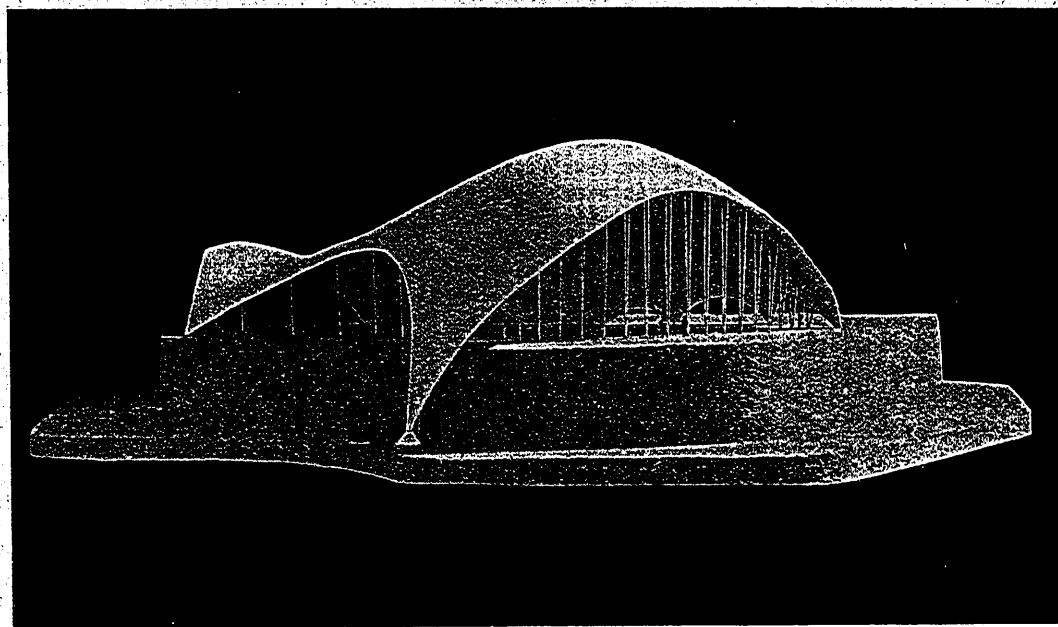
Maqueta de la cubierta para el Club Tachira, de Caracas.
